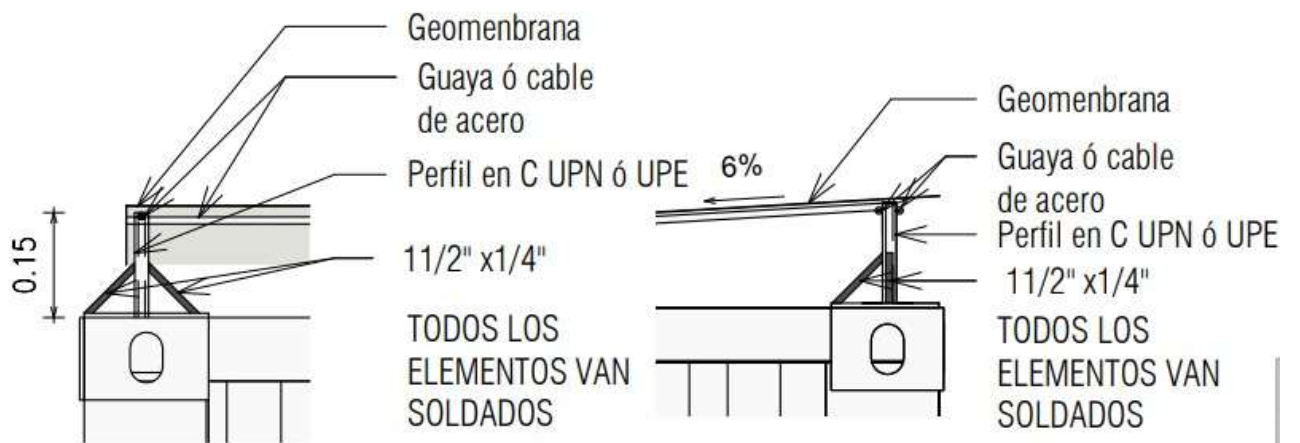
, Detalle anclaje contenedor a cubierta, 2025-II, Wilson Lozano
